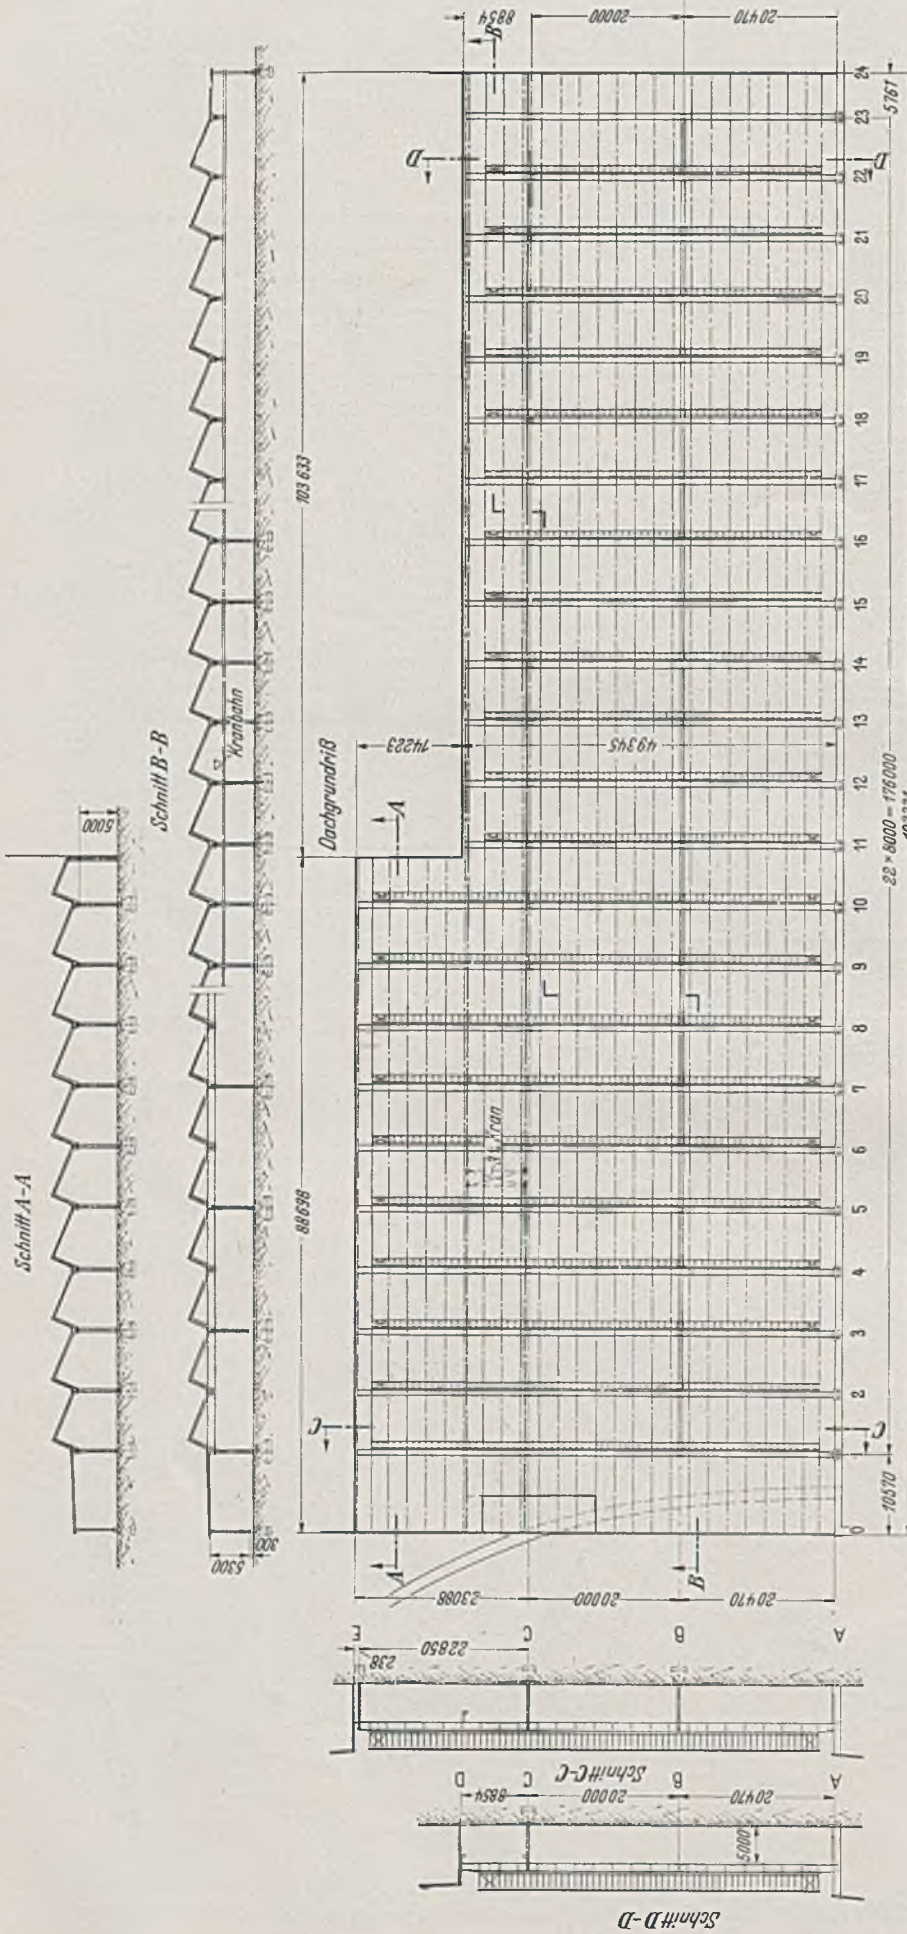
Bau 7: Grundriß, Quer- und Längenschnitte.
